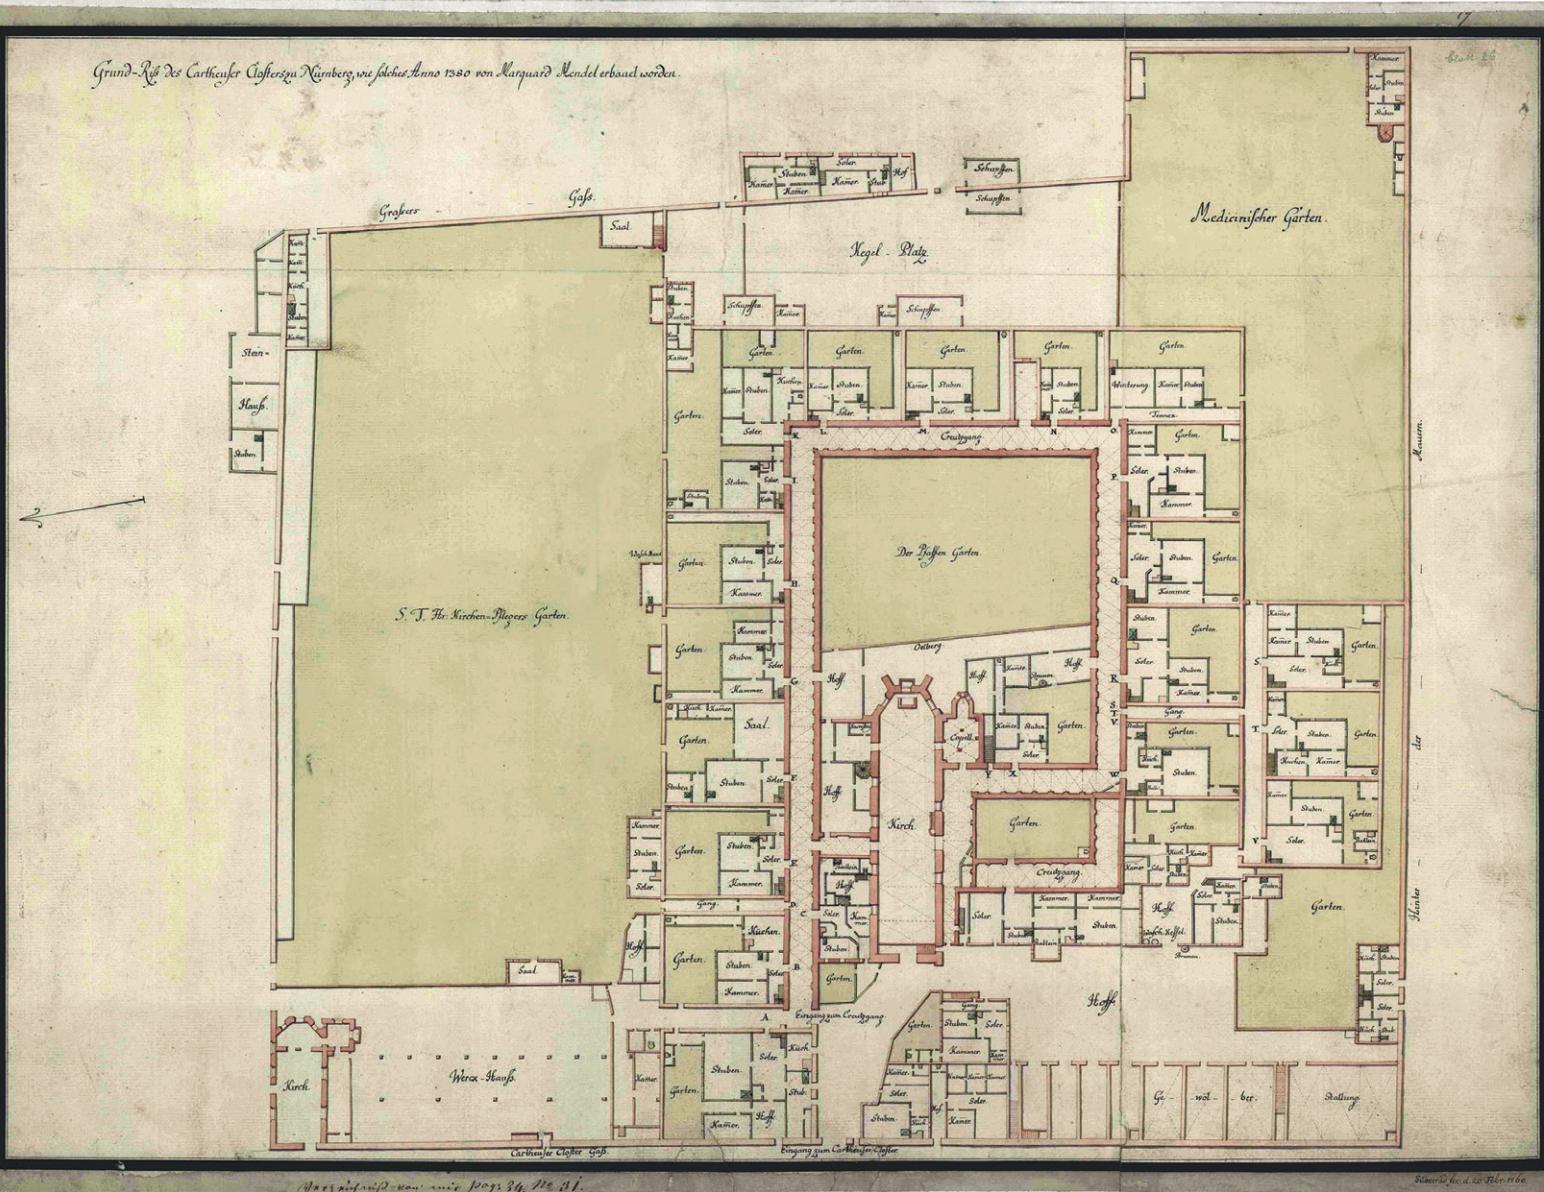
Ältester erhaltener Grundrissplan der Nürnberger Kartause von 1760.
